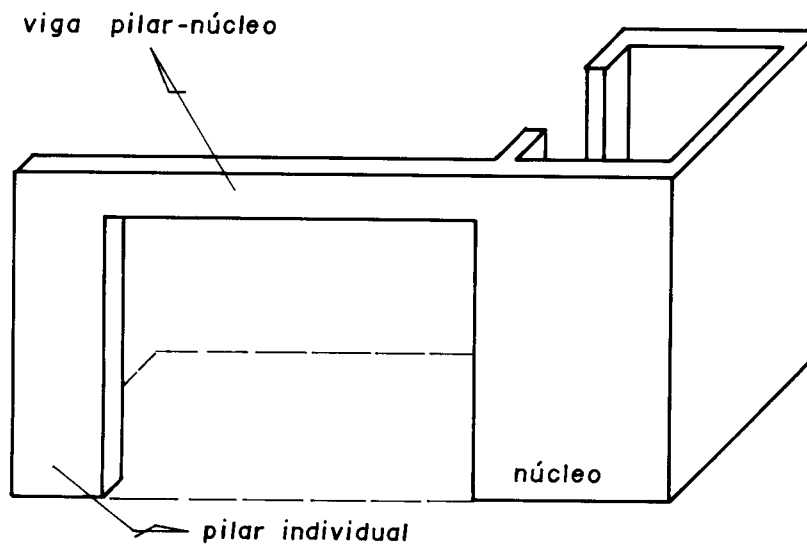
Contraventamento entre pilar individual e núcleo.
